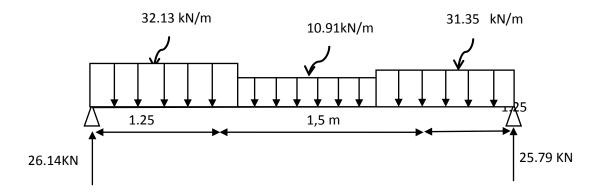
Schéma d'évaluation des charges (poutre brisée)
